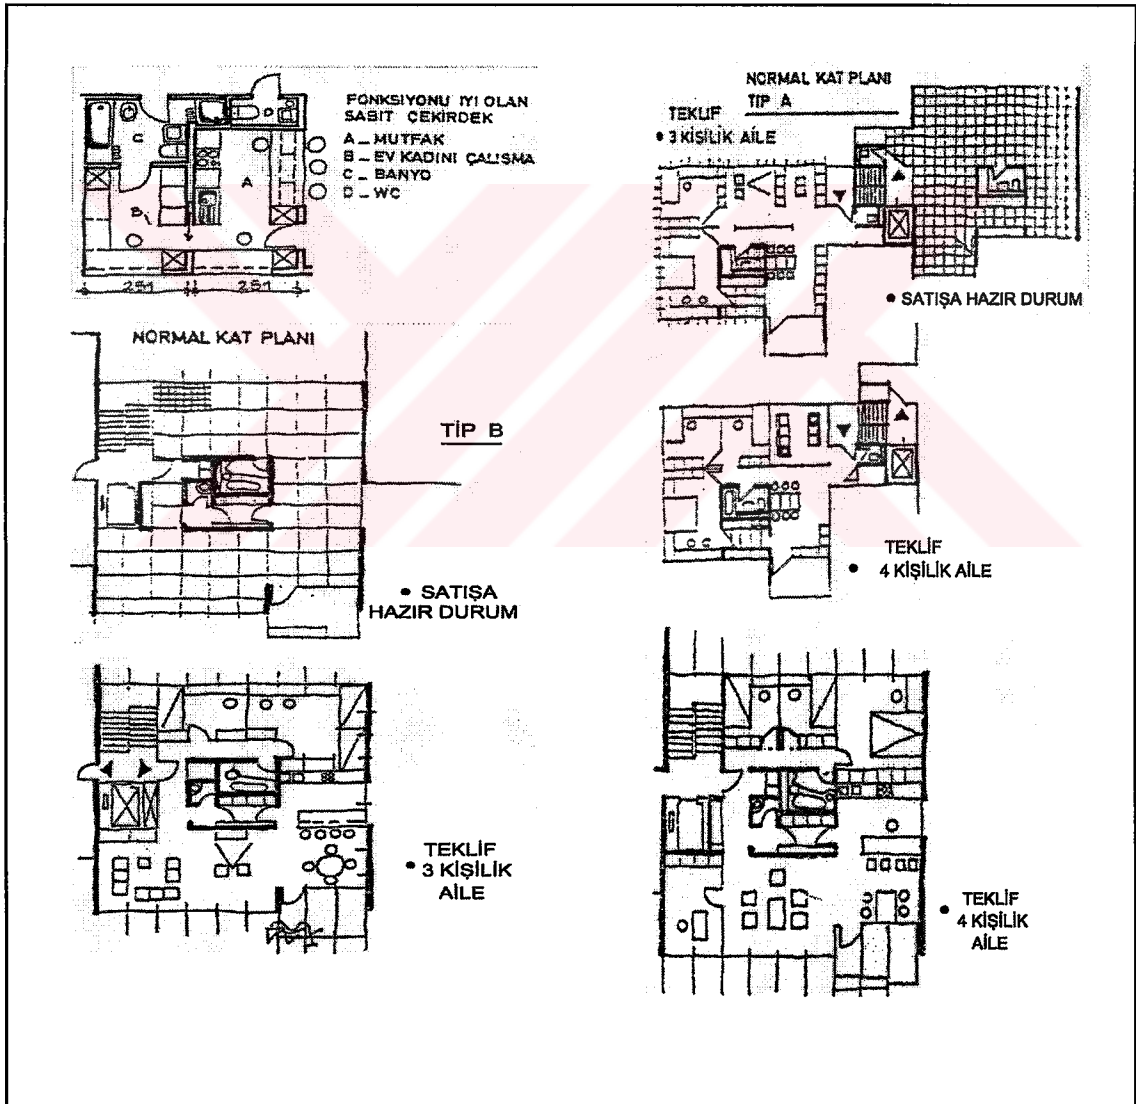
Farklı tipte aileler için değişebilir plan örnekleri
